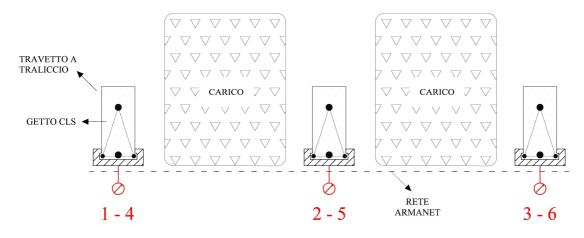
Sezione trasversale del solaio in fase di carico. Il carico è stato applicato mediante taniche riempite progressivamente d'acqua
